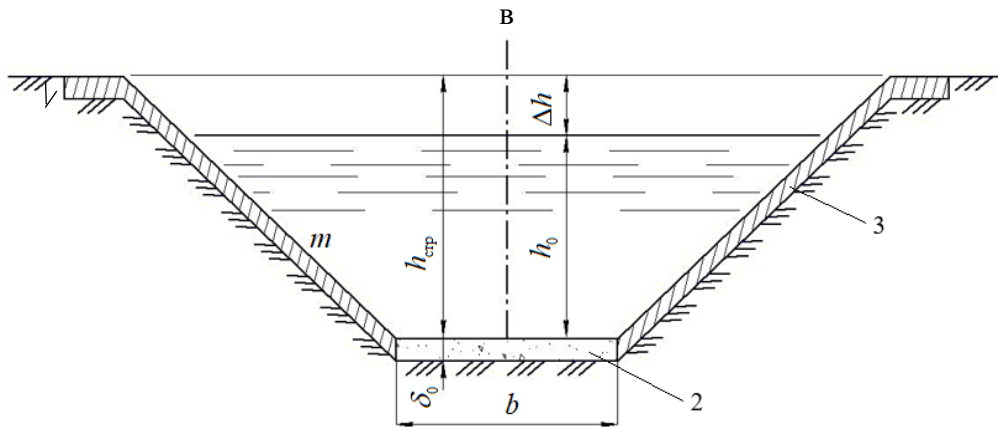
Схемы сечений оросительного канала с бетонными облицовками, лист 2:
